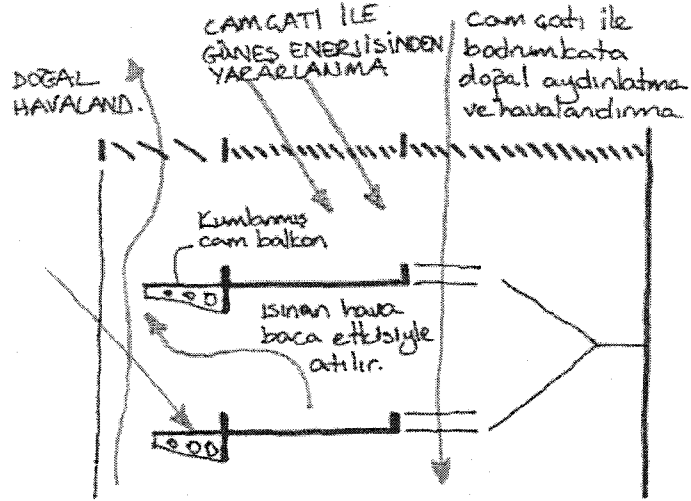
Y.T.Ü. Mimarlık Fak. binası, plan eskizi
